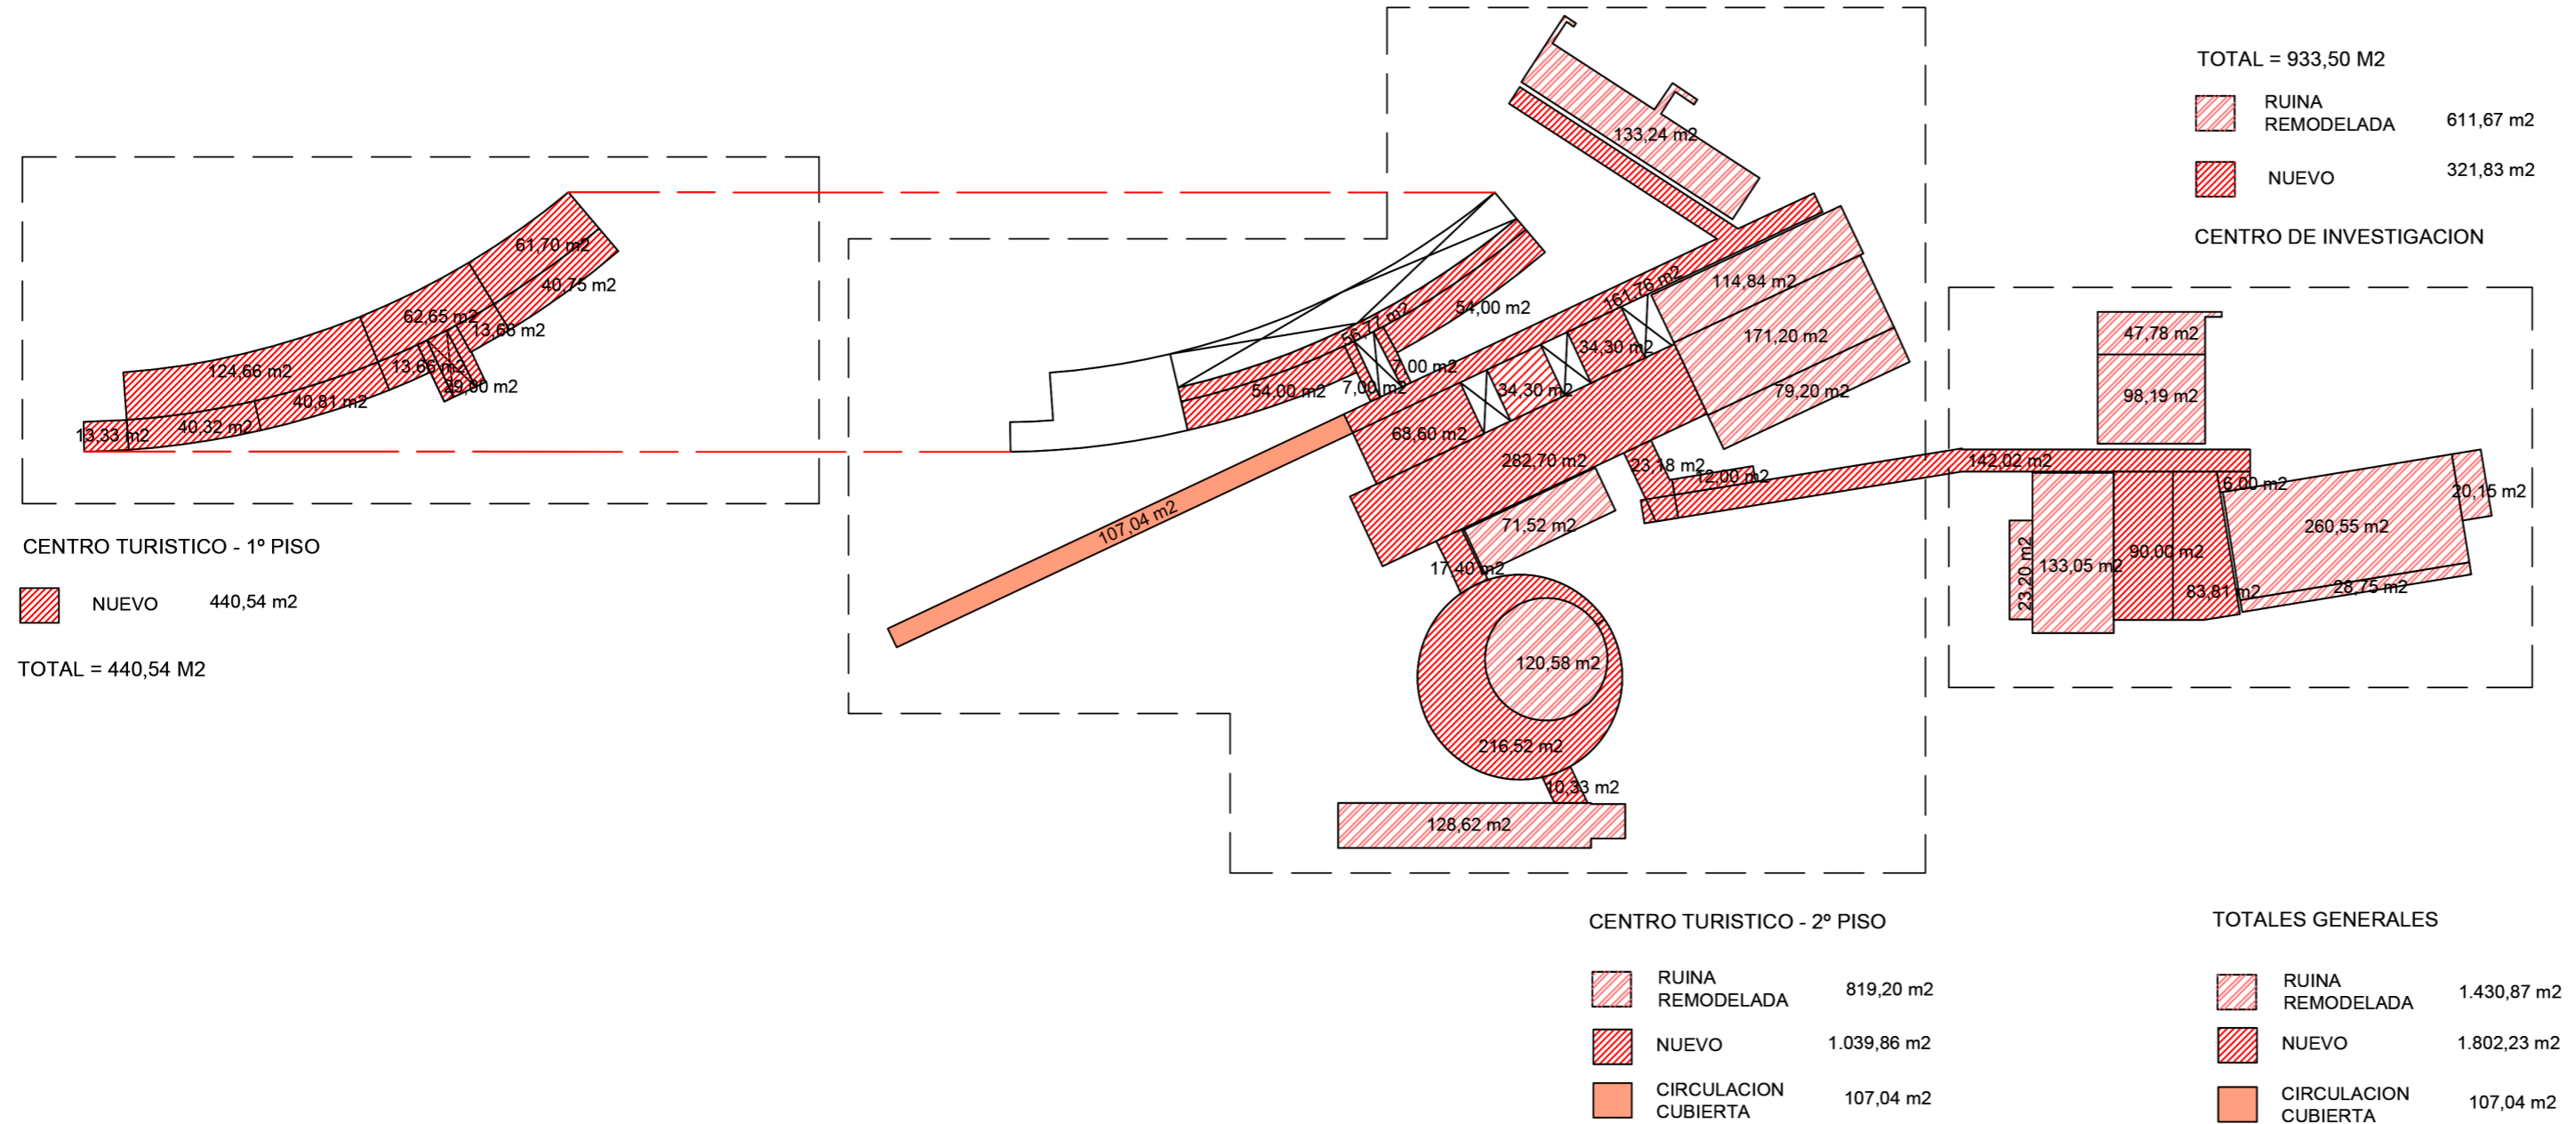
Planta Emplazamiento. Escala Gráfica.
